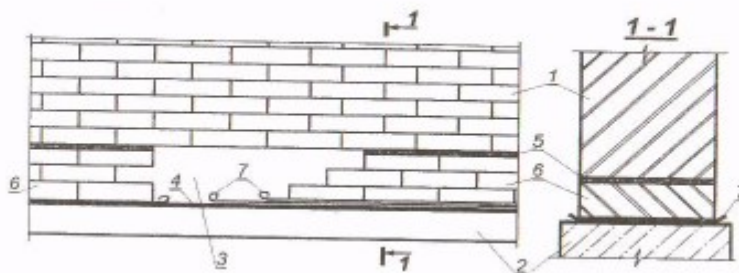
Замена или дополнительное устройство гидроизоляции:
